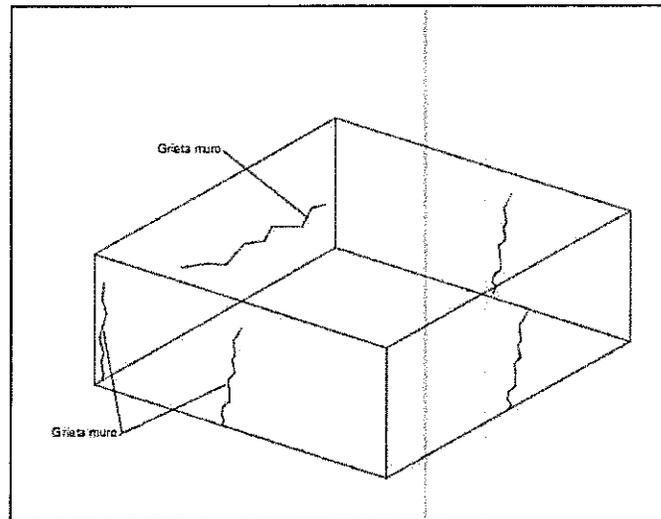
Principales grietas y fisuras. "fuente propia"
